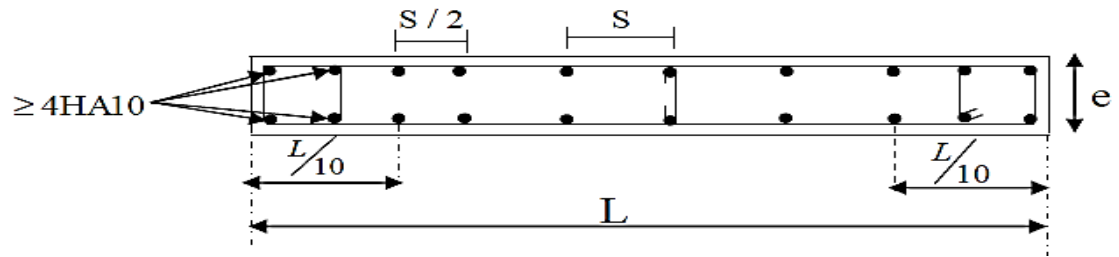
Disposition des armatures verticales dans les voiles.
